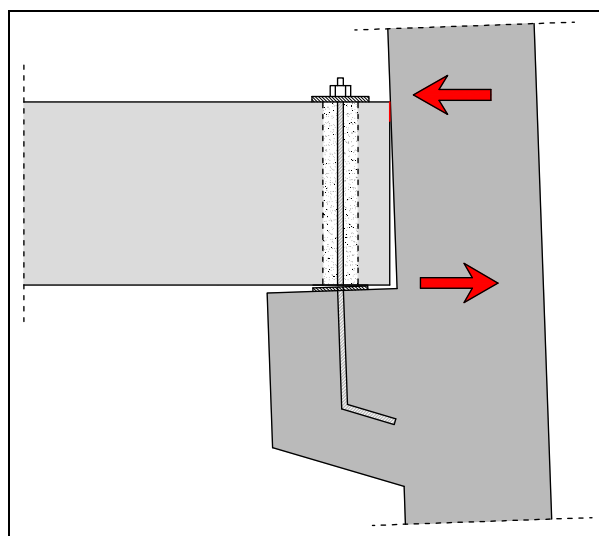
Forze nella connessione a contatto trave-pilastro avvenuto.
